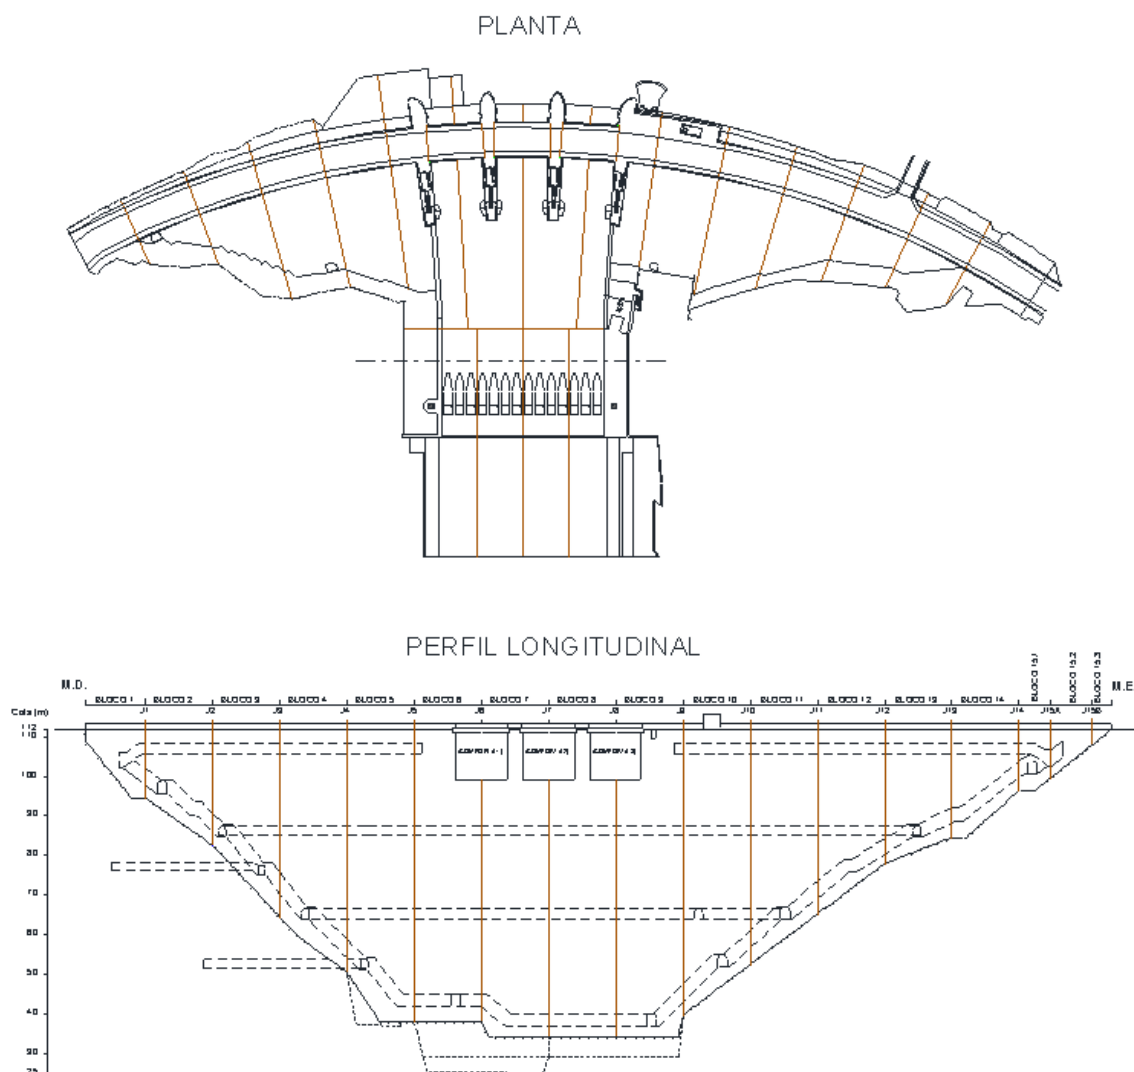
Barragem de Ribeiradio. Planta e vista desenvolvida do alçado de jusante
